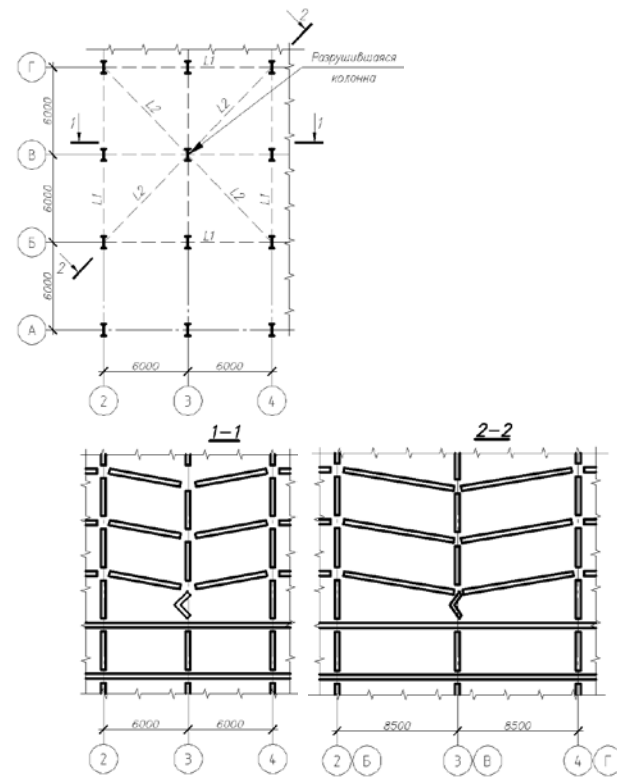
Схема второго механизма возможного обрушения плит перекрытия при разрушении колонны, относящейся к I группе
